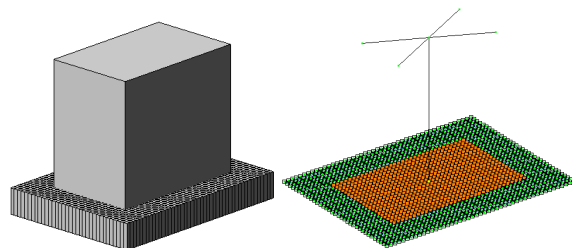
Общий вид и расчетная схема столбчатого фундамента
